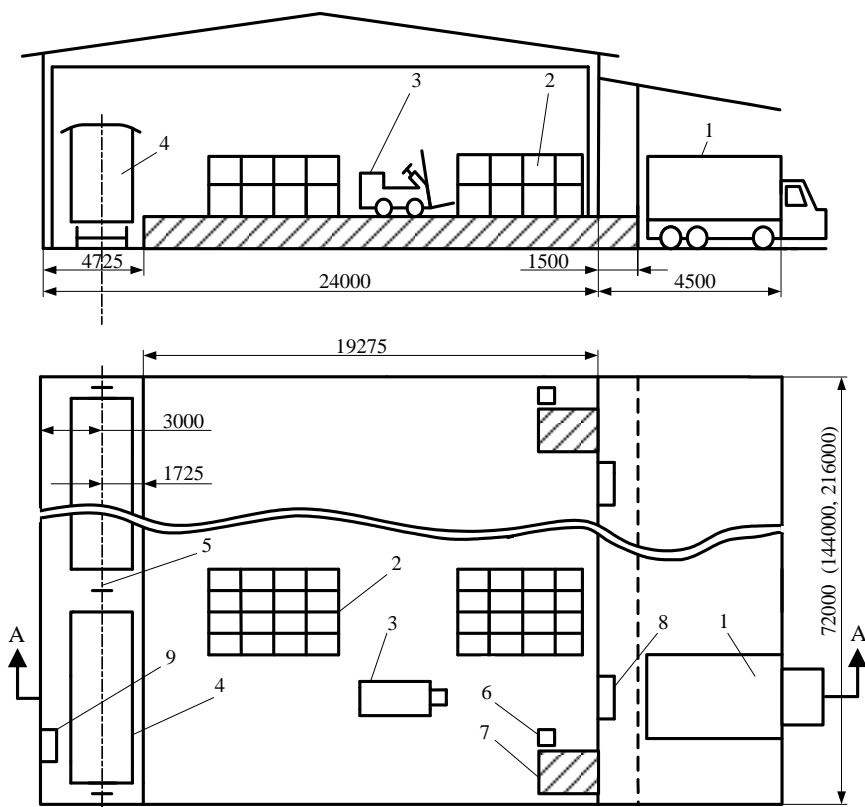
Схема КМАППР (вертикальный разрез и план) с использованием однопролетного крытого склада с внутренним расположением железнодорожного пути:
